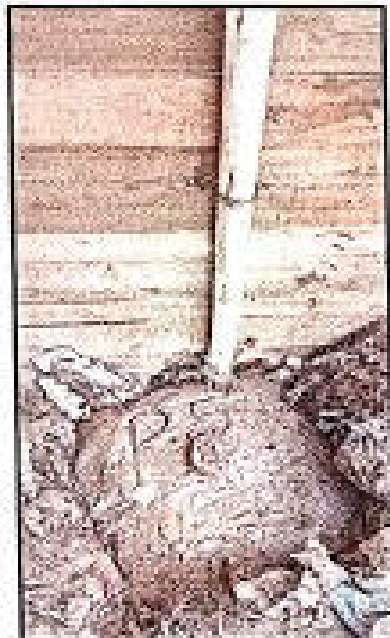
Vista del hito de concreto con tubo y varilla de 3/8" al centro.
